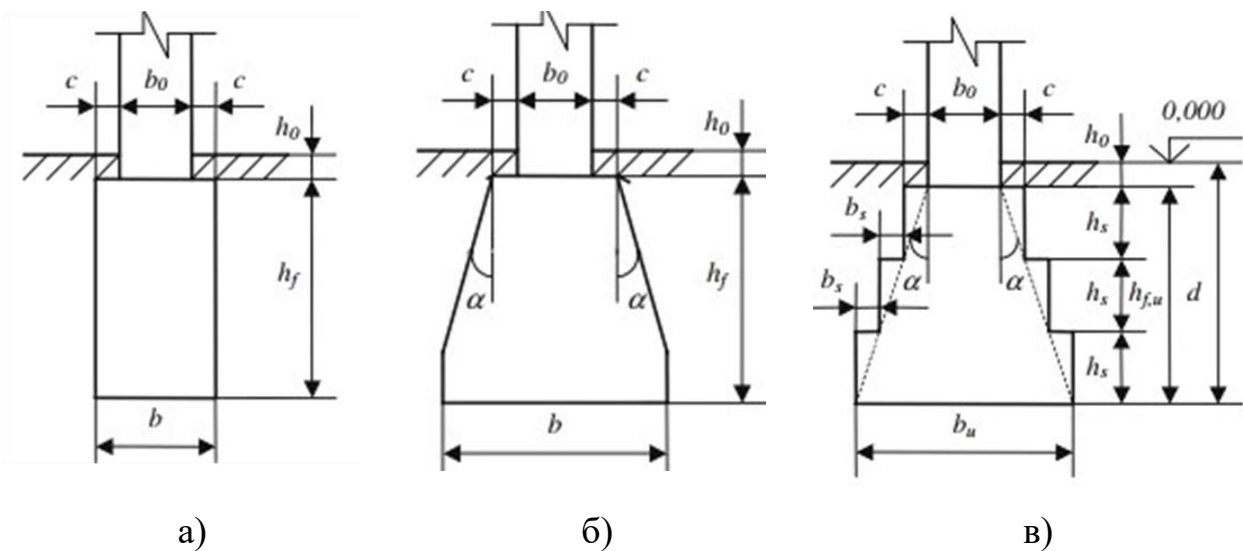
Схеми поперечного перерізу жорстких фундаментів:
